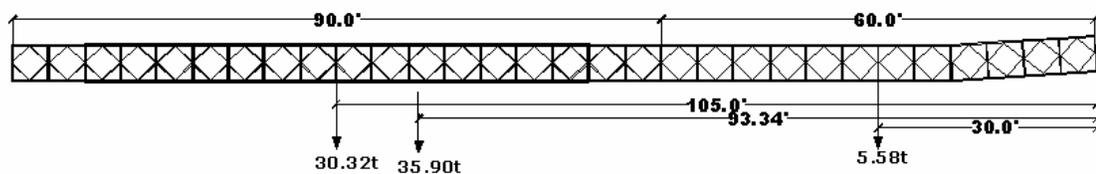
Ejemplo 4.1 Morro de lanzamiento puente Bailey D.S.90'R.4.M-2.
